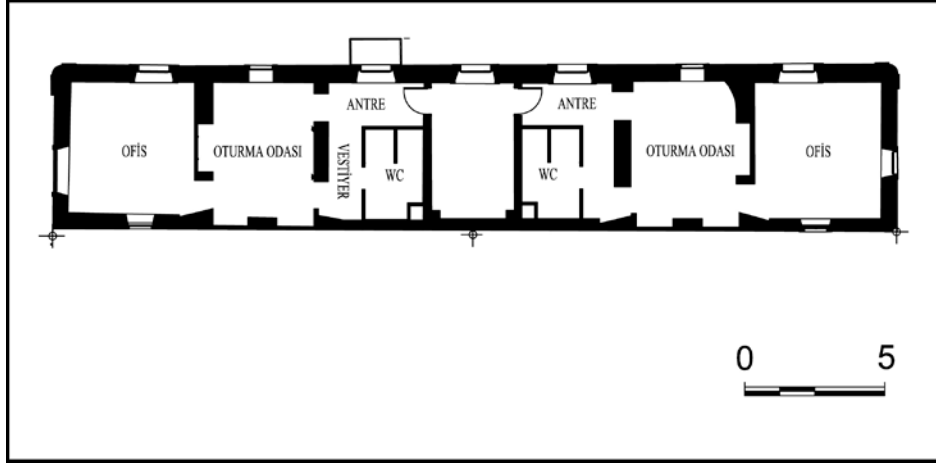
III. Dönem Kılavuz Kaptanlar Köşkü Giriş Kat Plan Şeması
